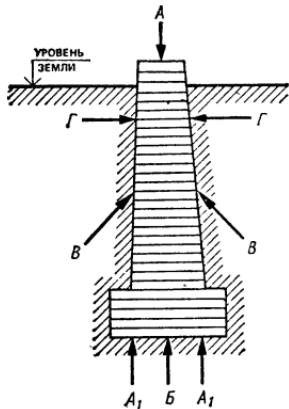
Силы, действующие на фундамент в пучинистых и подвижных грунтах
